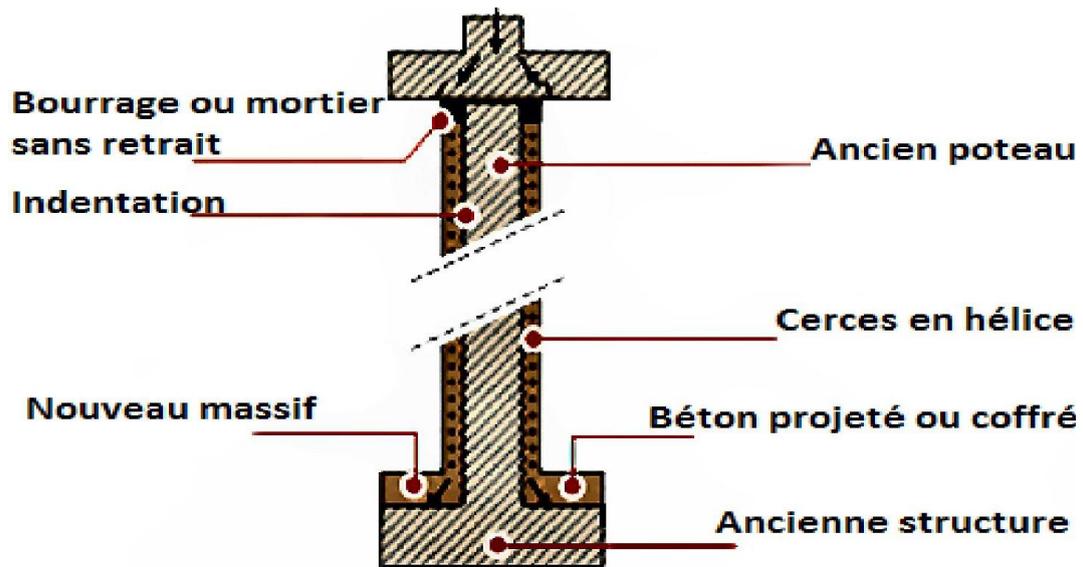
Chemisage en béton d'un poteau + fondation renforcée (coupe transversale)
